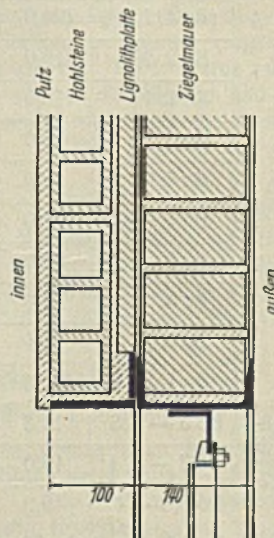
Einzelheit zur isolierten Wand des Anbaues.
